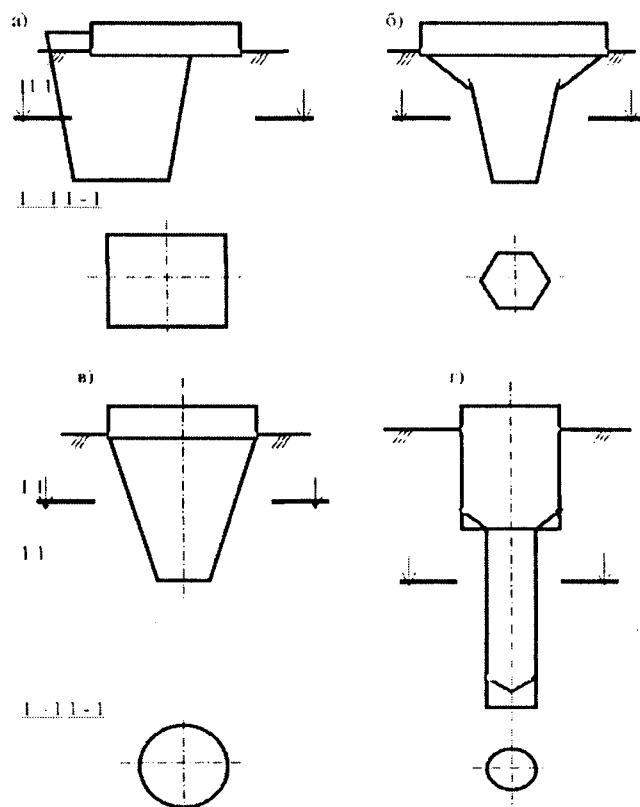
Схемы фундаментов в вытрамбованных котлованах.
